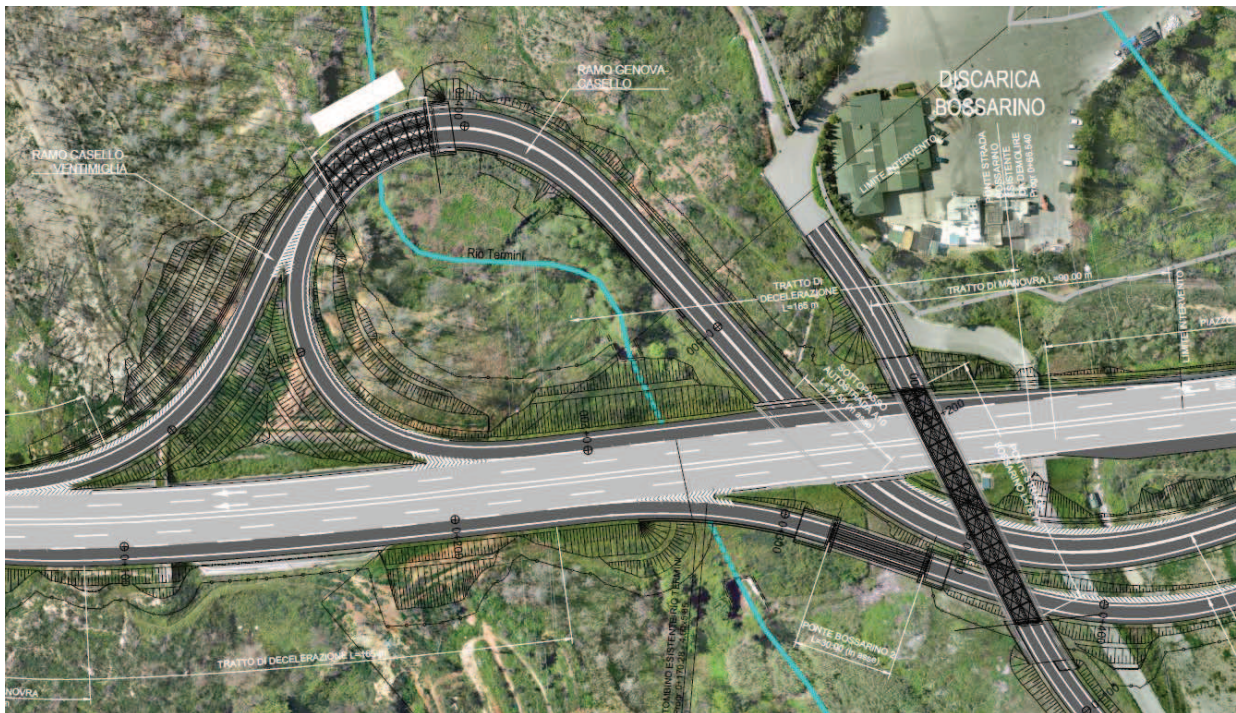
Stralcio della planimetria di progetto nella zona del casello
